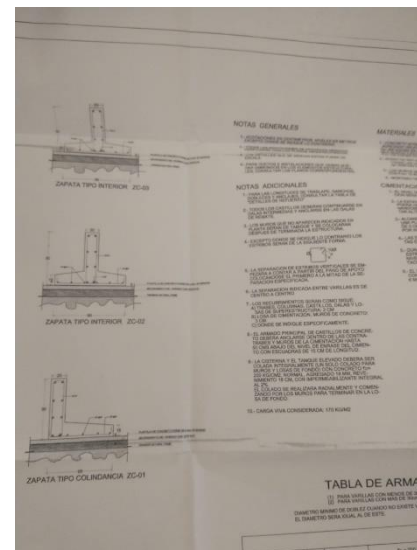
,10 y 11. Evidencia de revisión de planos que fueron ingresados para trámite de Licencia de construcción. Se me encomendó la revisión de la parte estructural del proyecto.
